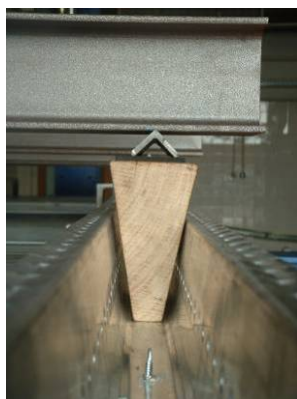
Barrote de madeira colocado entre as almas de um perfil MadreMax.
